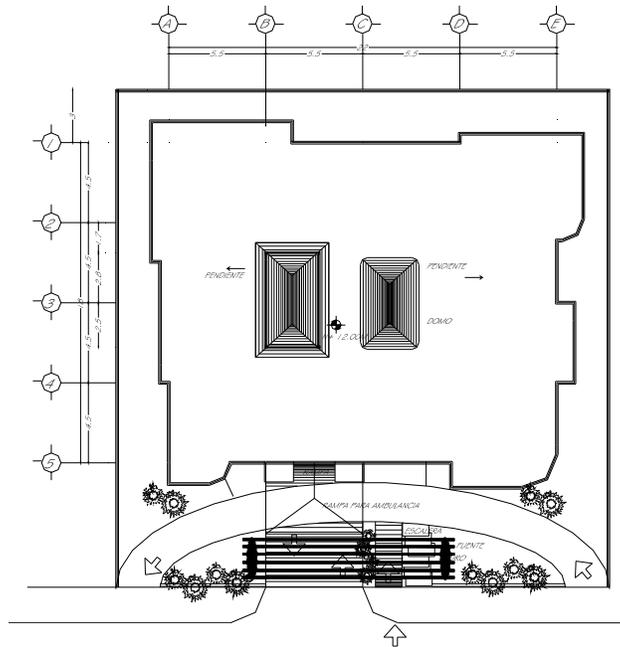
PLANTA AZOTEA N+12,00 m
